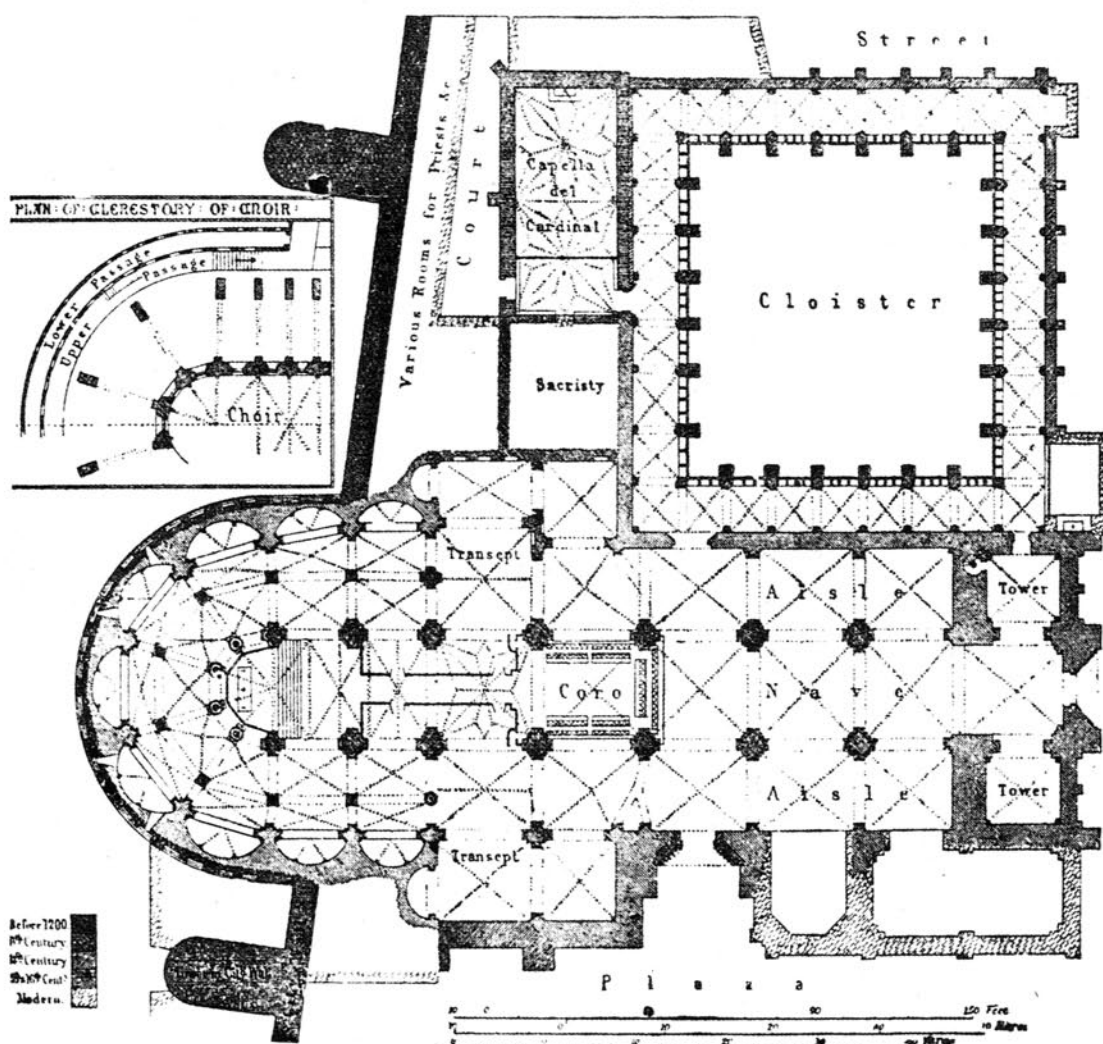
Planta de street publicada en "La Arquitectura gótica en España", 1865.
